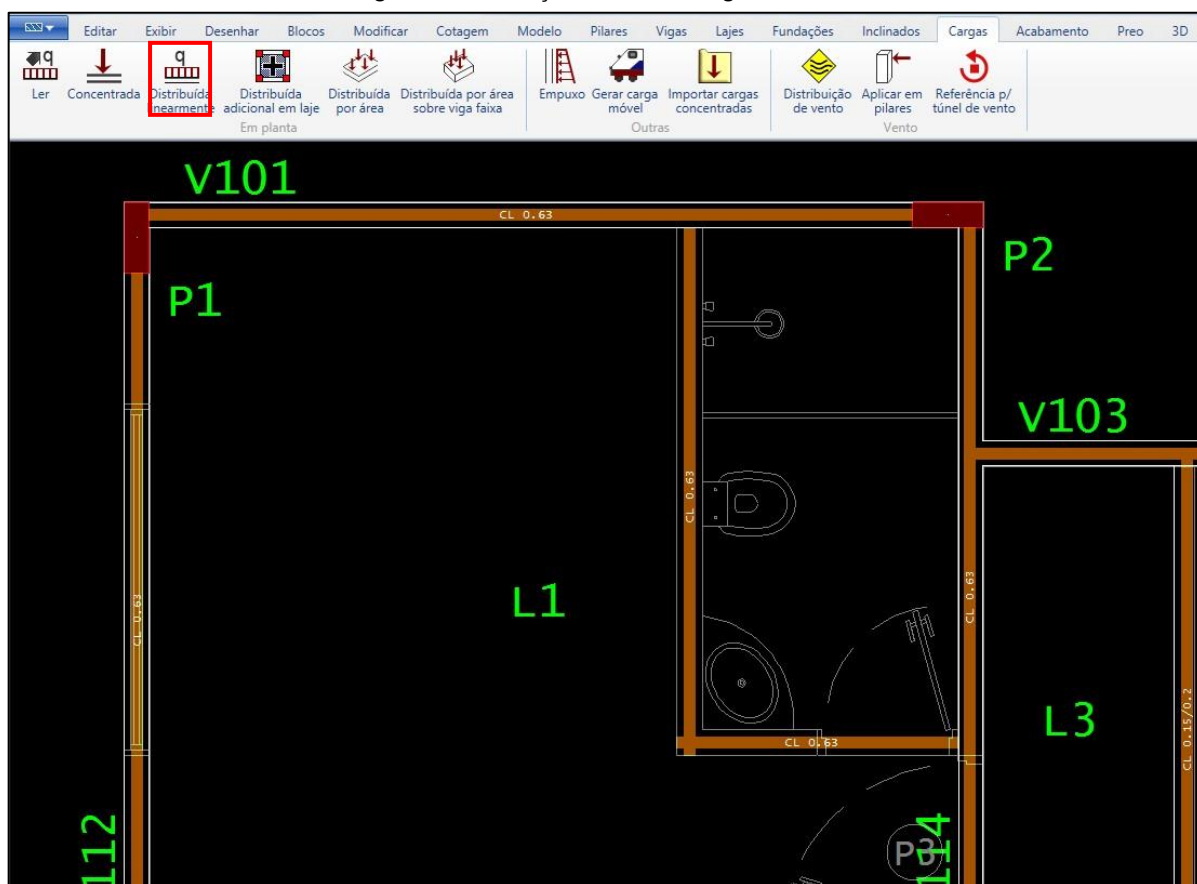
Ferramentas do modelador estrutural na aba vigas
